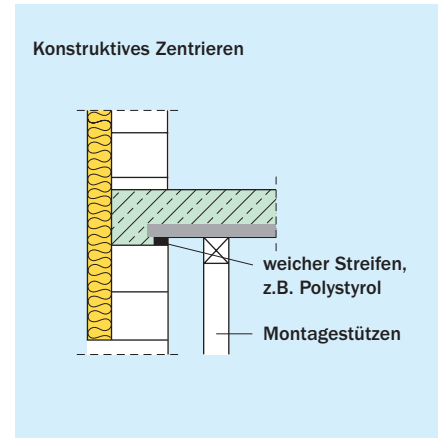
Einlage weicher Streifen zur Lastzentrierung
